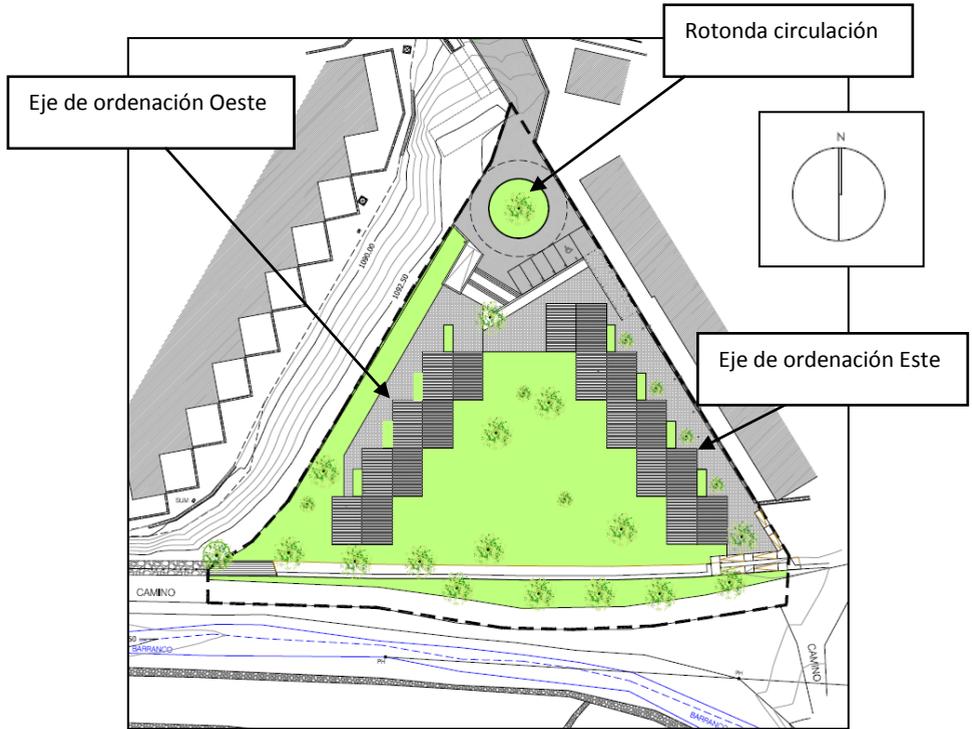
Ejes de la edificación y vía de circulación. 2017. Plano o.05 Texto Refundido PERI 3.
